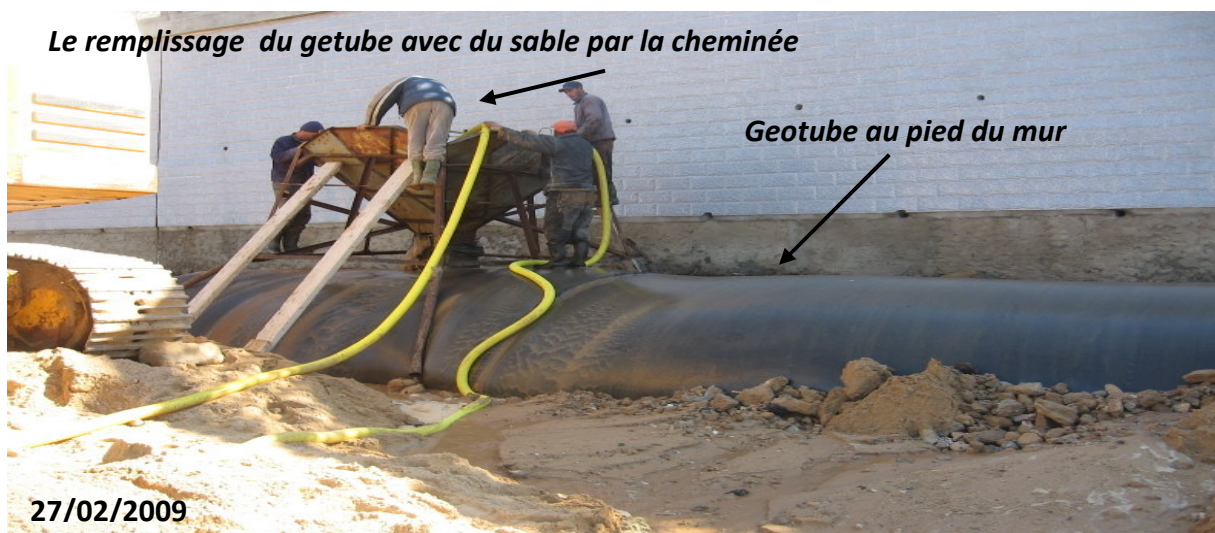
photographie de la mise en place du géotube au pied du mur (HMI).
